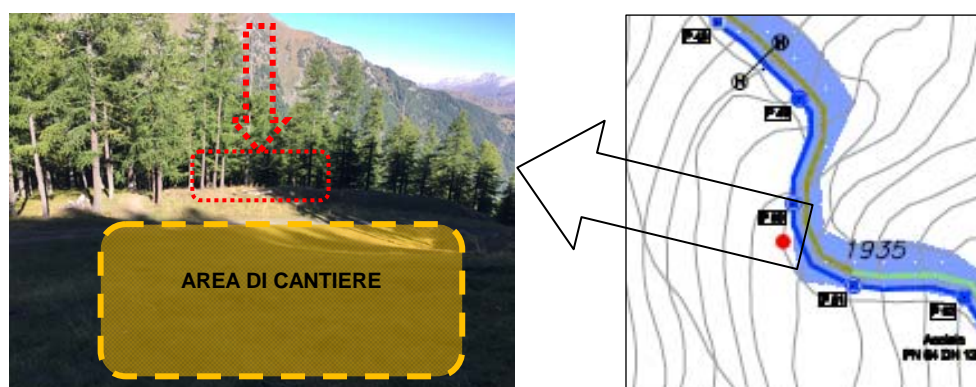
Localizzazione vasca e individuazione area di cantiere Località Miandette
